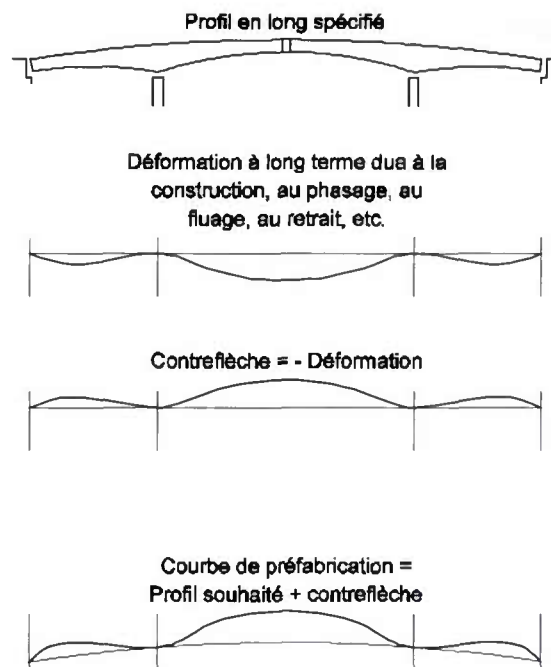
Courbe de bétonnage d'un pont en encorbellement type
